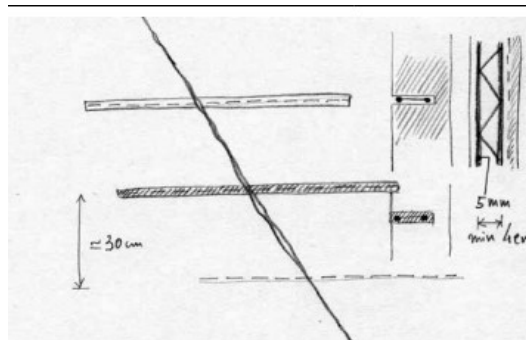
ilustração de inserção de armaduras em cunhais. Fonte (Arquivo pessoal, 2020)
